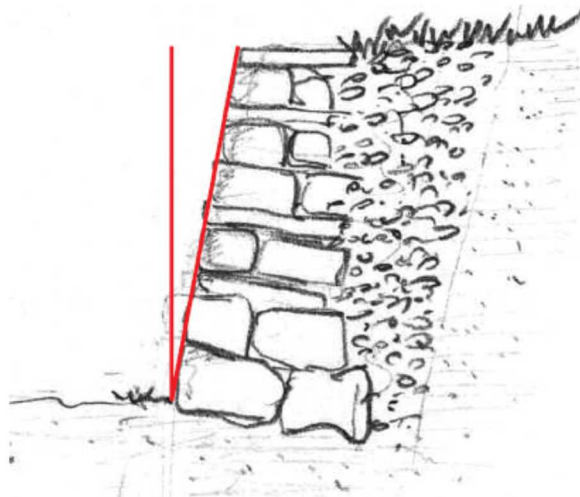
Sezione corretta di un muro a secco di contenimento con inclinazione della scarpa del 10% rispetto alla verticale
